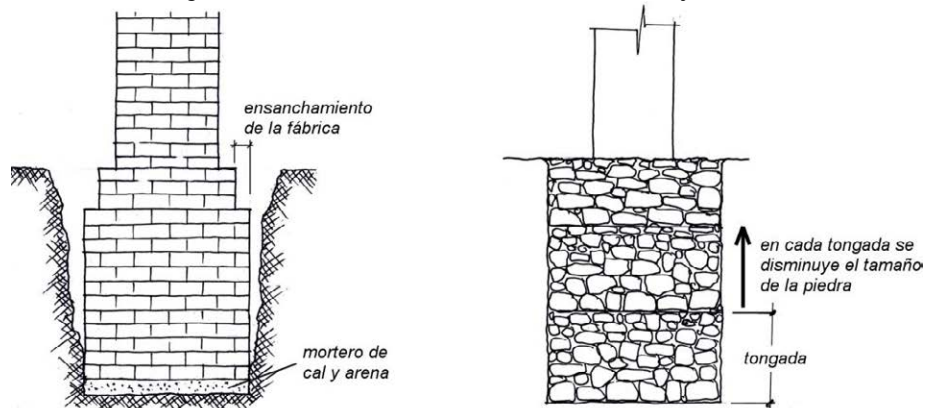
Diferentes sistema de cimentación bajo muro
